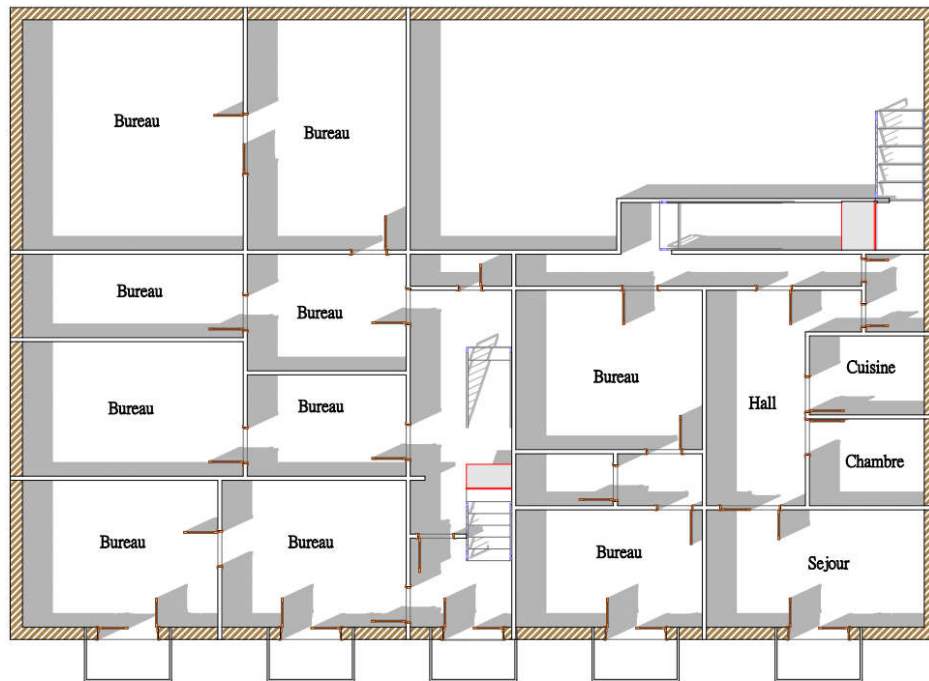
Plan premier étage, édifice colonial B2 (T1) au niveau de centre-ville de Tébessa.
